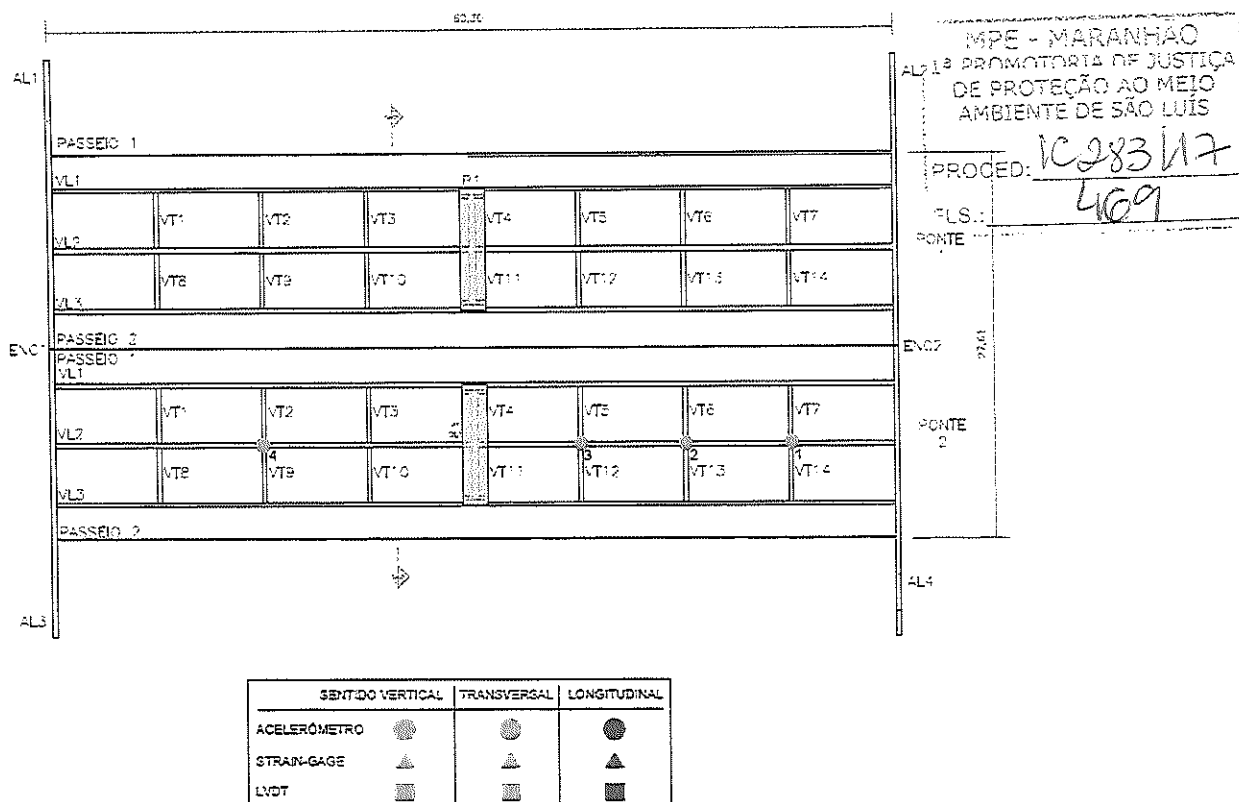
Pontos de monitoramento para a Configuração 3 – vista em planta
